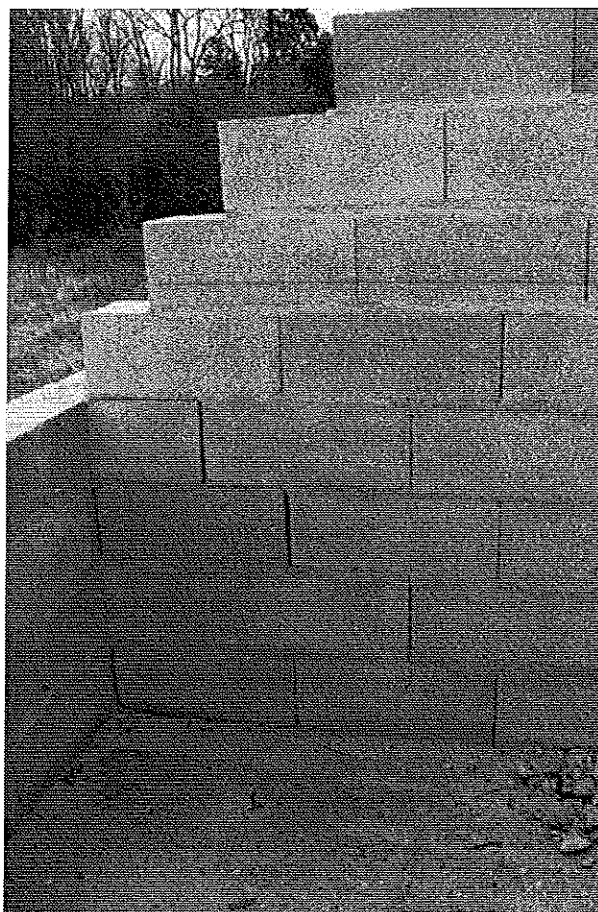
Détail refend. Fissure en escalier dans la zone en débord (console). © J. Putatti
